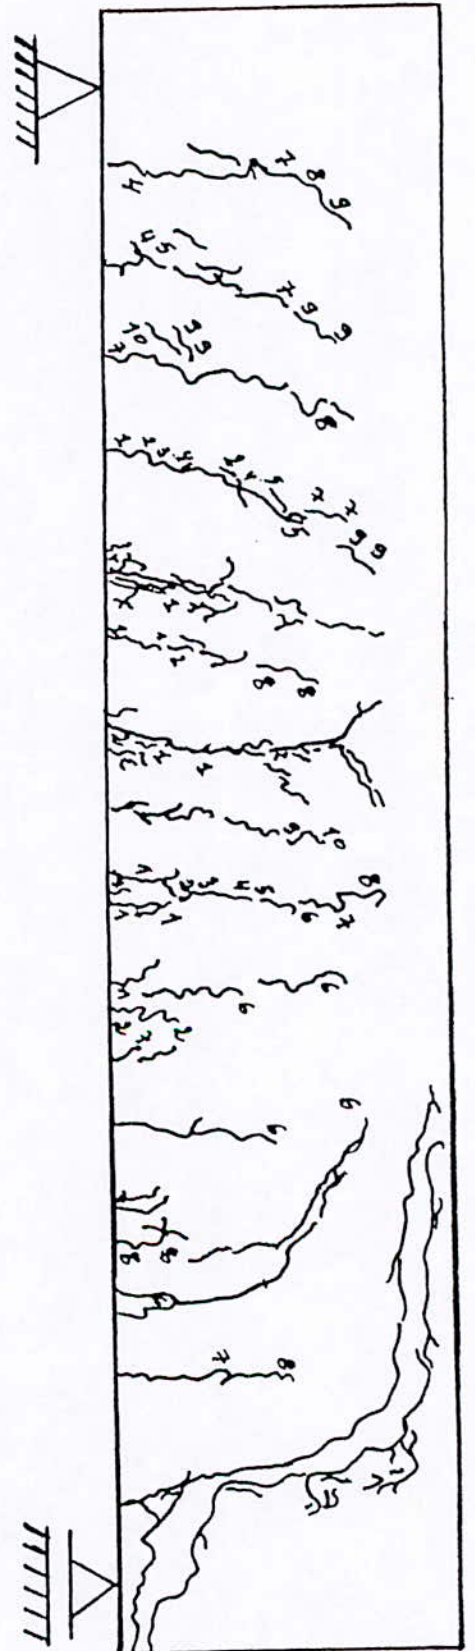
Schéma de fissuration de la poutre F1A
